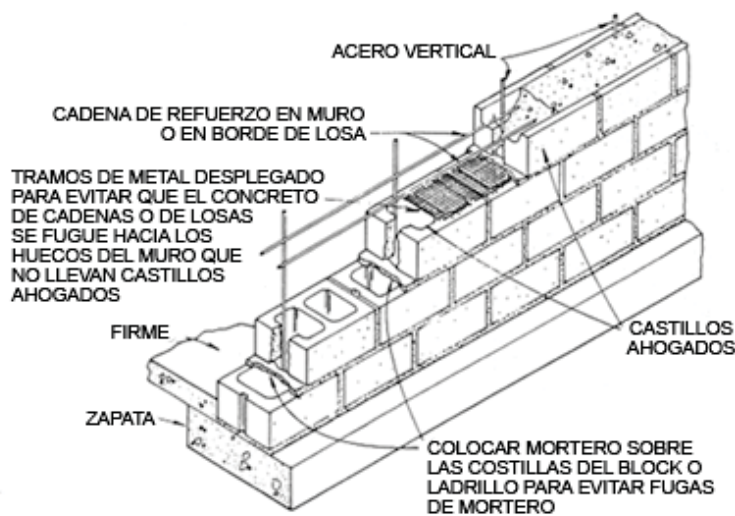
BARRERA DE METAL DESPLEGADO EN FONDO DE CADENAS para evitar la fuga del concreto hacia los alveolos de la parte inferior del muro hueco.
